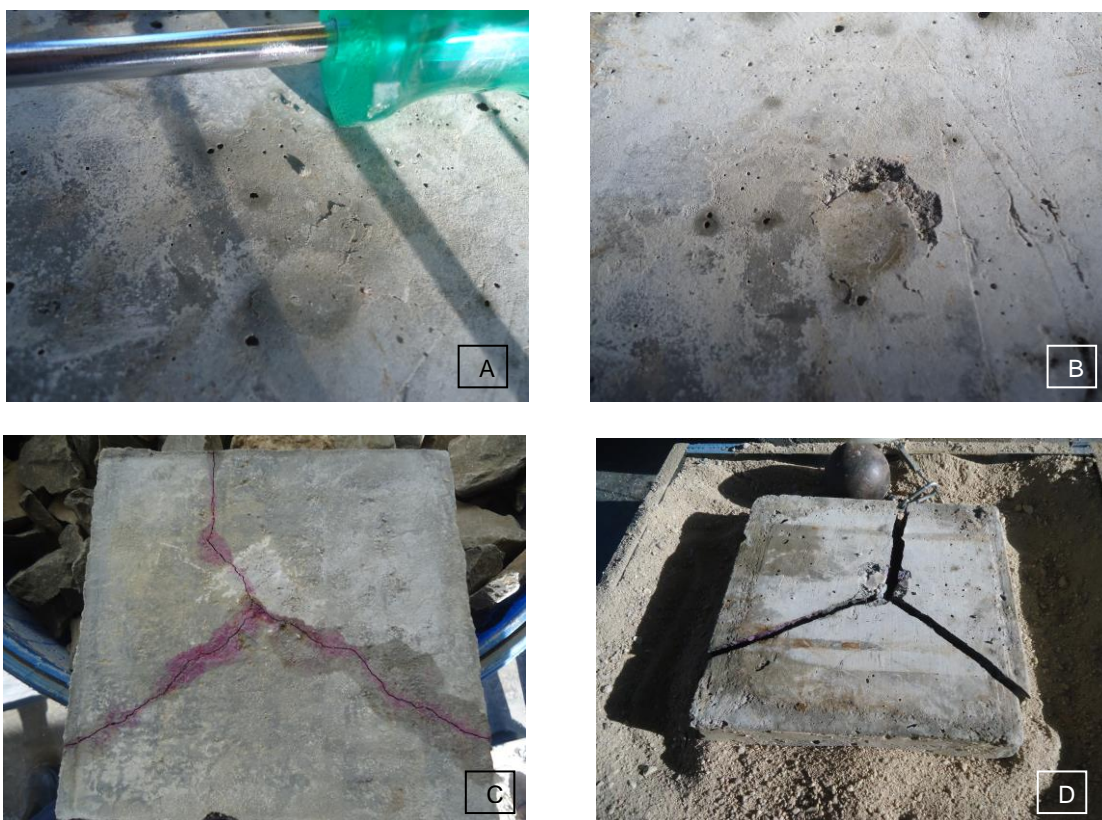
IMAGENS DOS CORPOS DE PROVA DE CONCRETO REF DURANTE O ENSAIO DE IMPACTO: (A) AMASSAMENTO; (B) DESPLACAMENTO; (C) FISSURAS; E (D) RUPTURA
